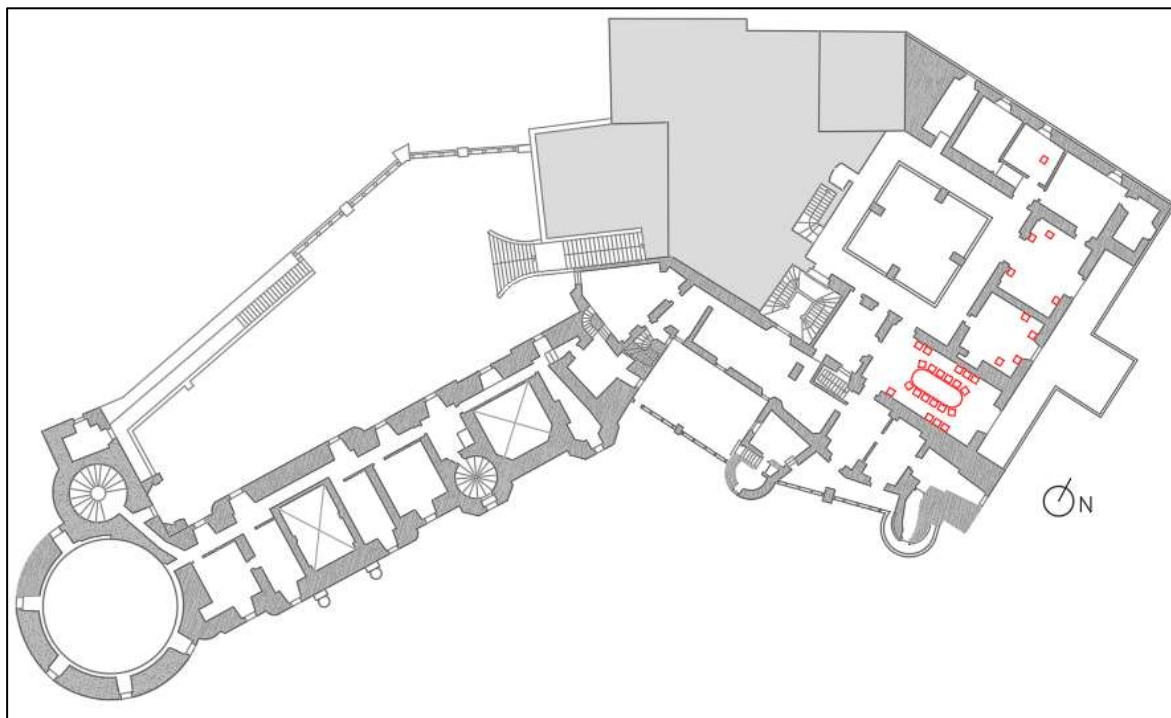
Piso 1 com a localização das cadeiras. Planta ©PSML, sem escala.
